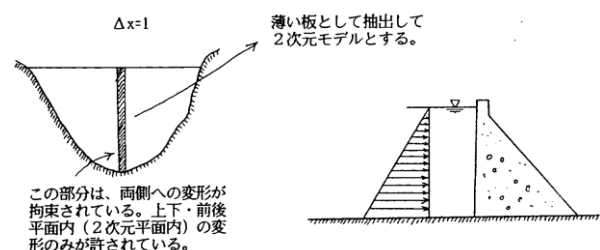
重力式ダムの2次元モデル化（平面ひずみ状態）
